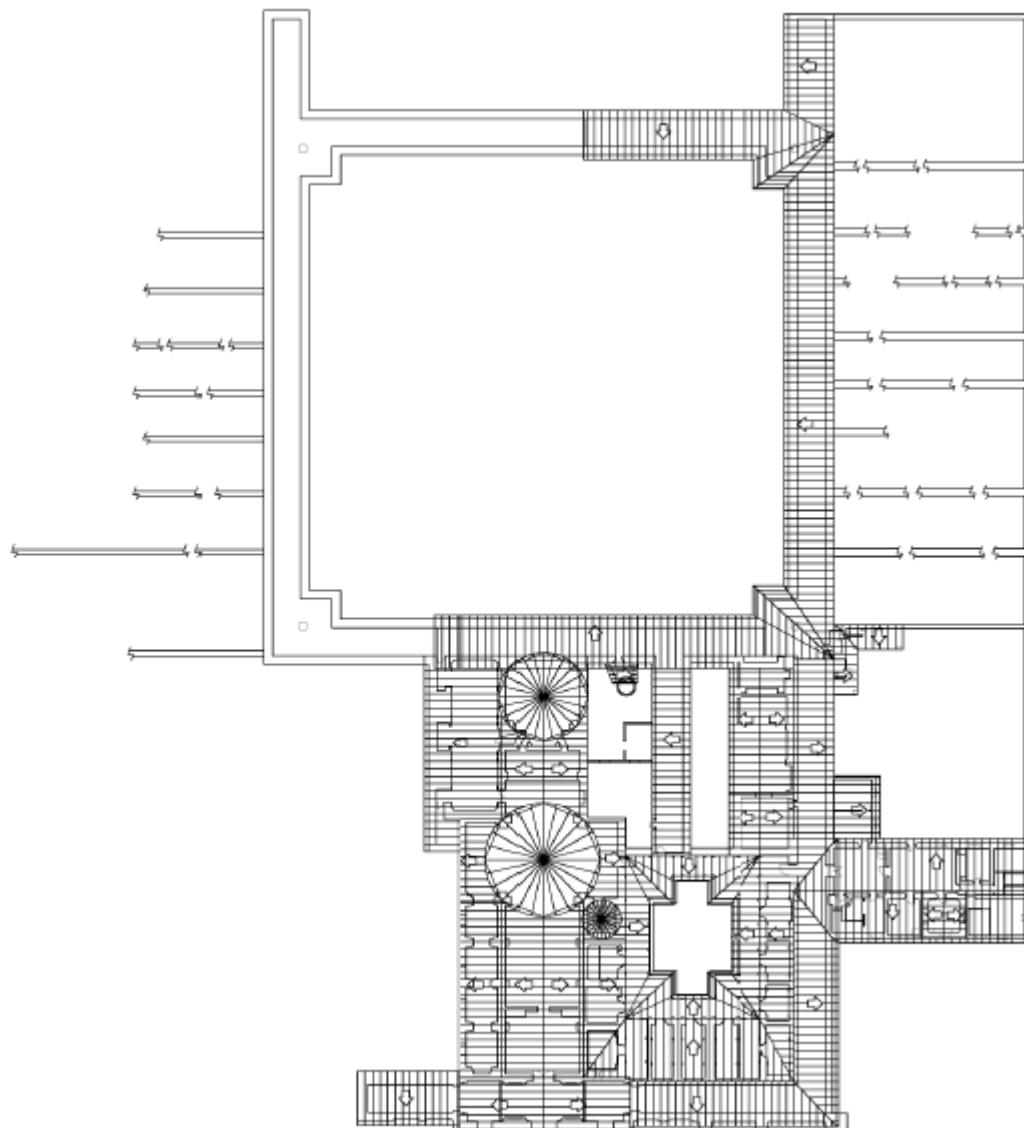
Plano general de las cubiertas de la Cartuja.
